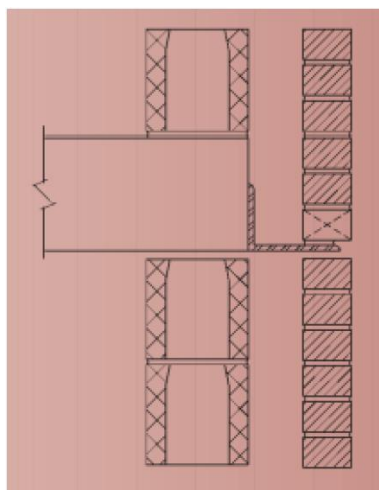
Corte esquemático do apoio do pano exterior de tijolo com face à vista em cantoneira [63]
